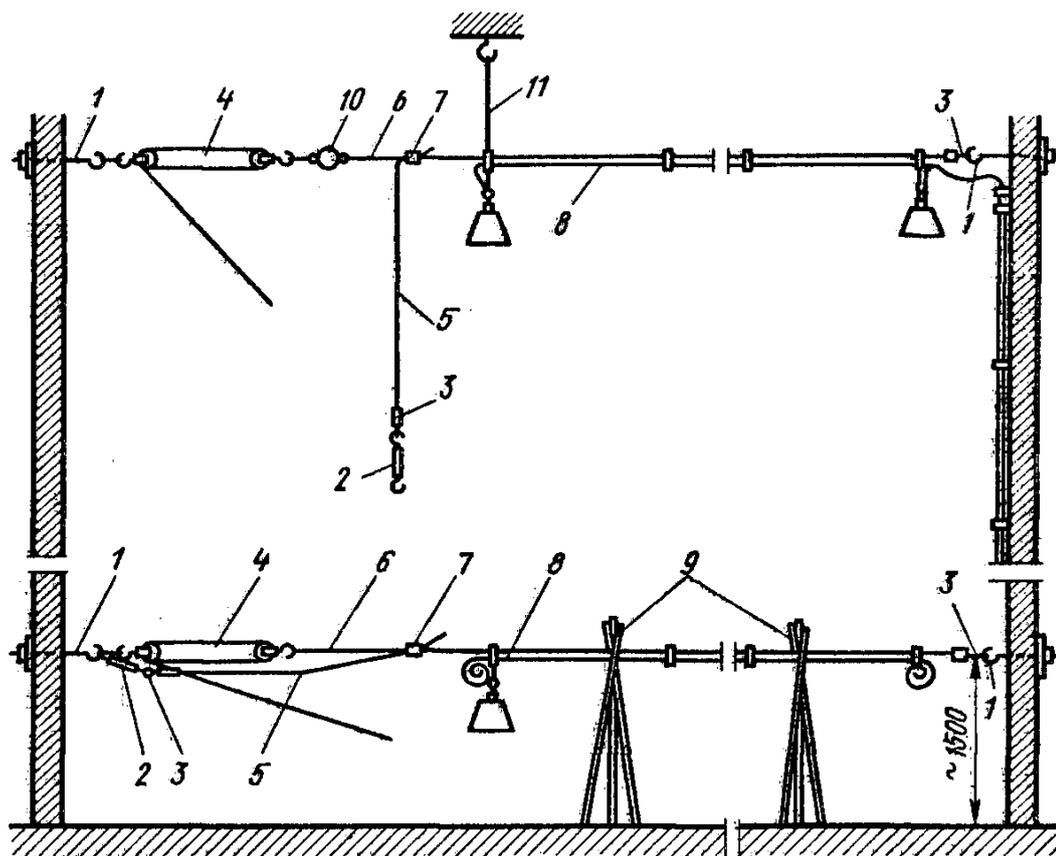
Схема сборки и подвески тросовых электропроводок на месте монтажа: 1 - временные и постоянные анкеры; 2 - натяжная муфта; 3 - концевые петли; 4 - специальная лебедка или полиспаст; 5 - свободный конец несущего троса; 5 - вспомогательный отрезок троса; 7 - клиновой зажим; 8 - плетть тросовой электропроводки; 9 - инвентарные подставки; 10 - динамометр; 11 - вертикальная проволочная подвеска
